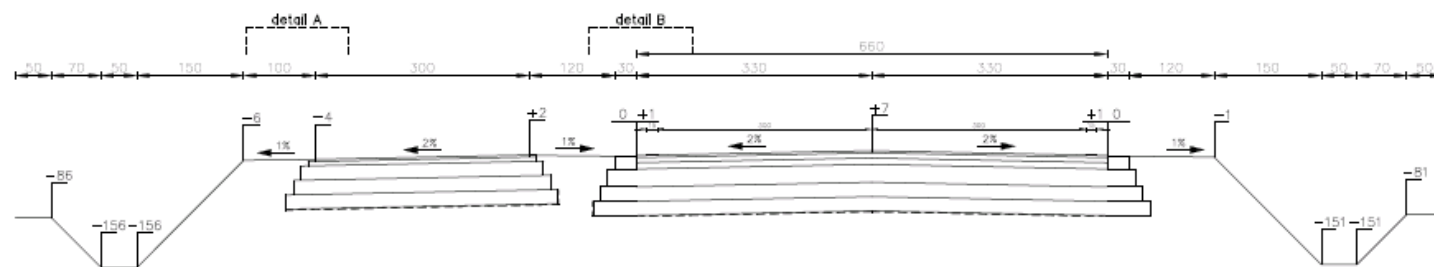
Doorsnede van de opbouw van de Mallebaan.
